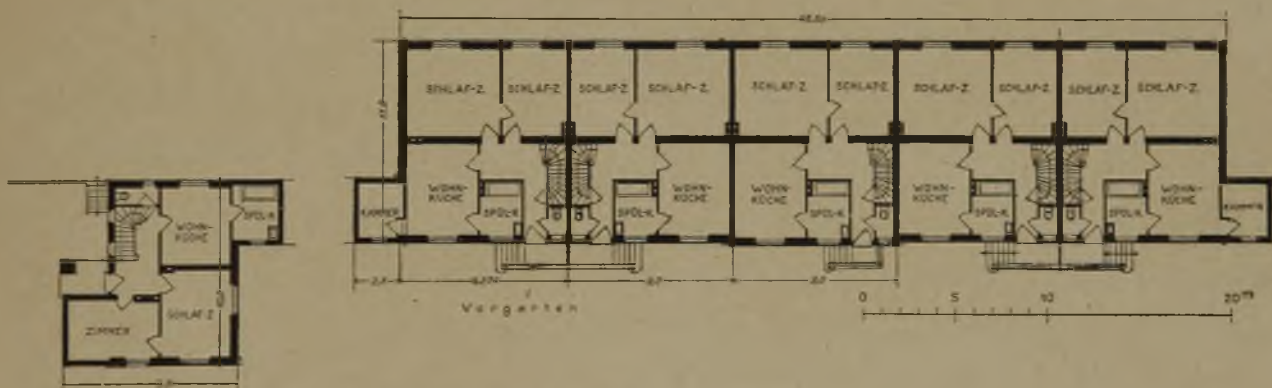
(hierüber). Grundriß des Erdgeschosses.
